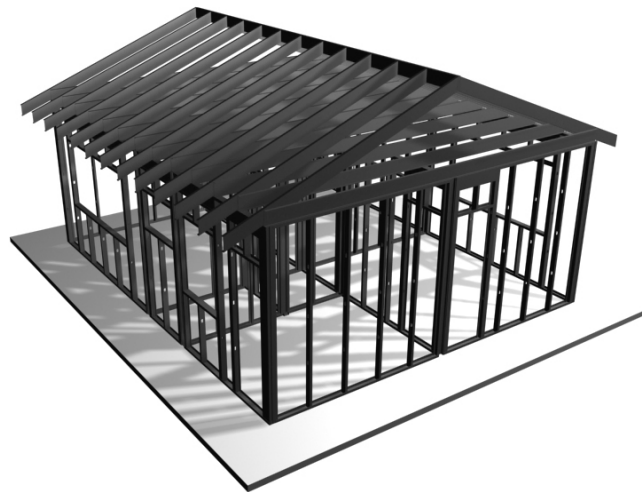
Desenho esquemático da estrutura do modelo simulado em *Light Steel Framing
